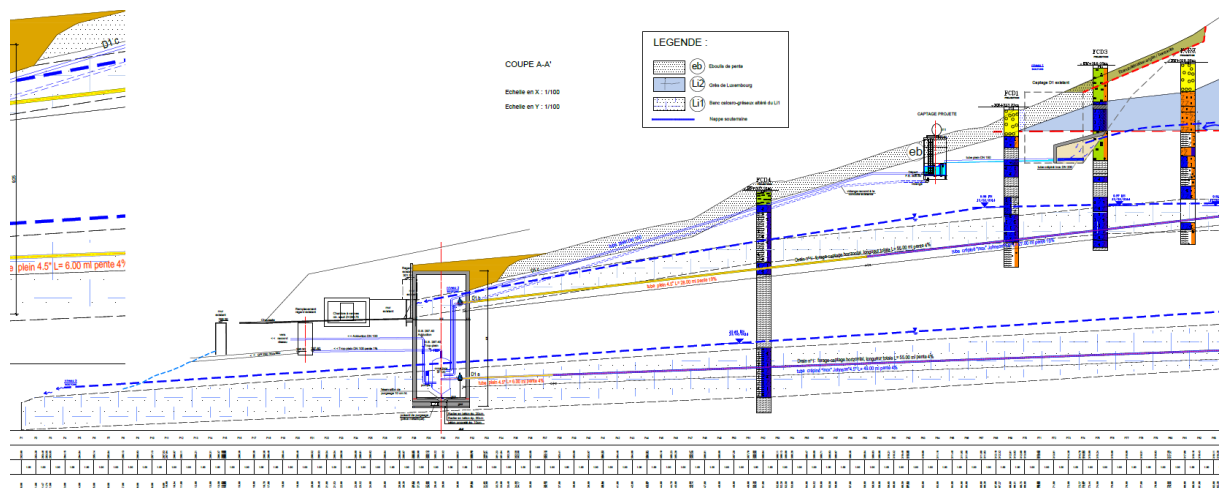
Plan schématique „Captage D1 Dommeldange- Concept d'assainissement (AVP)“, Coupe (Géoconseils 2014)
